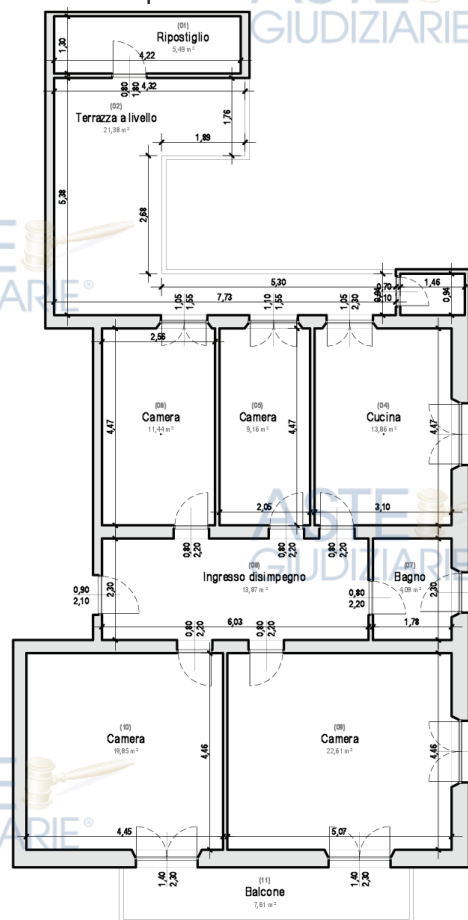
Rilievo dello stato attuale e sovrapposizione tra stato attuale e progetto di sopraelevazione del 1996
